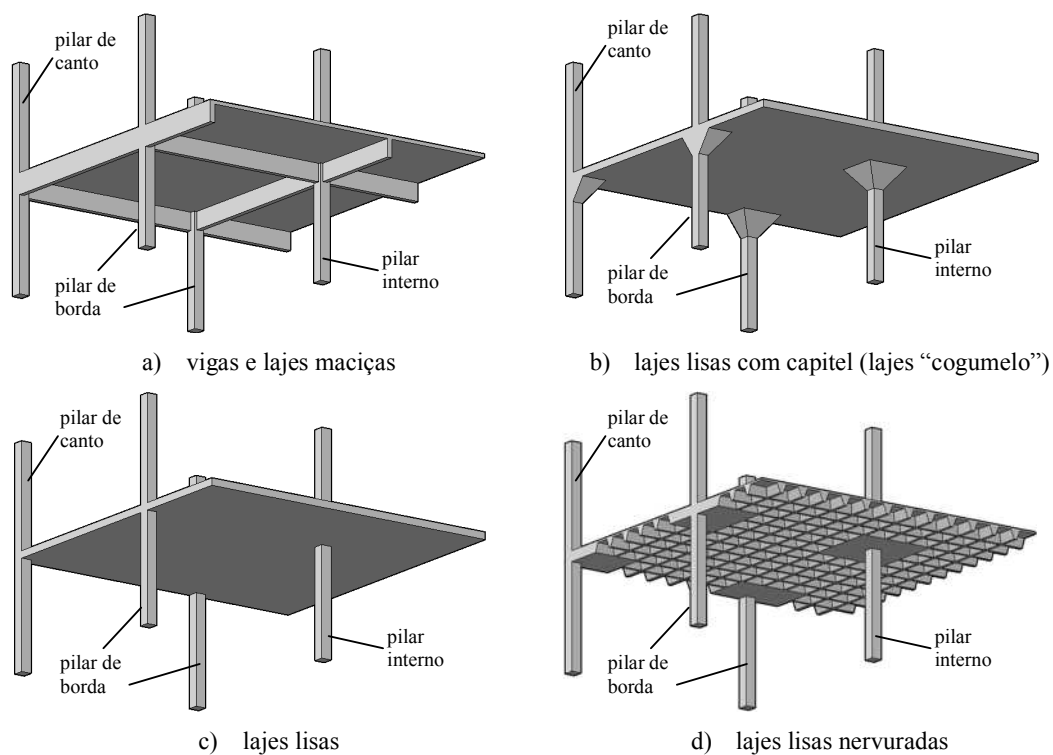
Sistemas estruturais para estruturas de concreto
